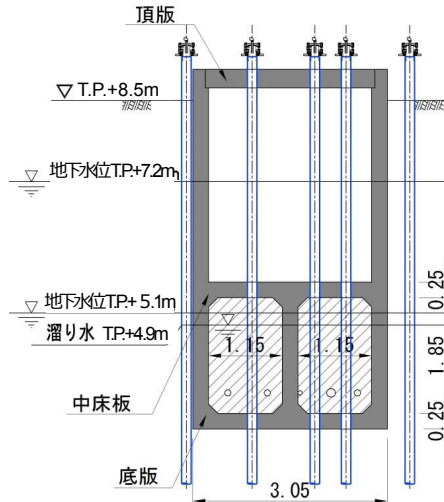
【5-2】2号機主変圧器ケーブルダクト 施工方法（貫通施工）
